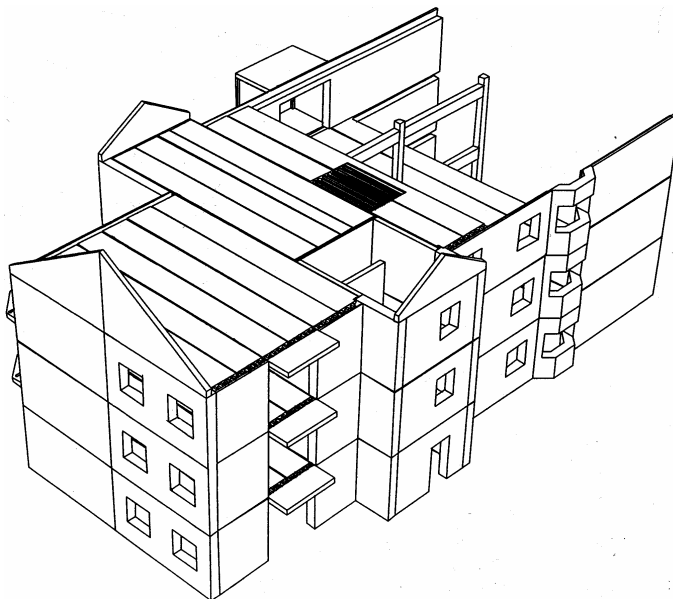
esquema de edifício de apartamentos com paredes portantes na fachada. Quando o vão total entre as fachadas opostas for muito grande, são empregados pilares e vigas intermediárias para apoio das lajes.
